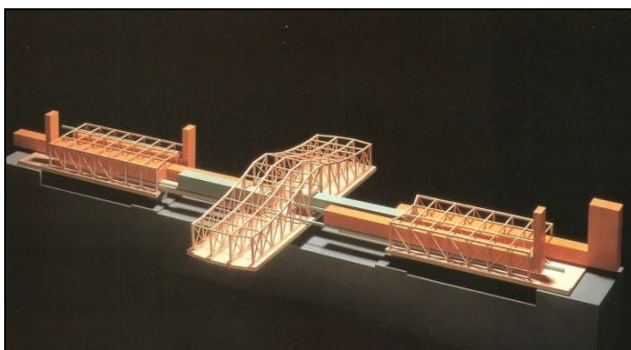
, Wellington Reiter, Northern Avenue Bridge, Boston, Massachusetts: maquete, 1996.
